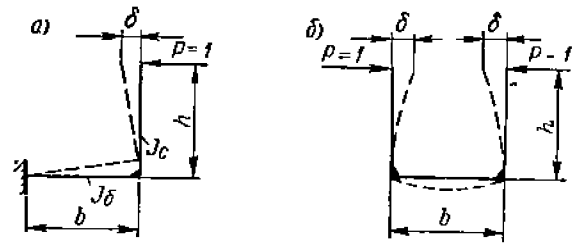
Схемы рам с открытым сжатым поясом: а — один пояс; б — два пояса
